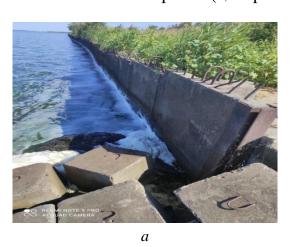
Первая очередь строительства берегоукрепления (автор фото С. Я. Семененко) Figure 6 – First stage of bank protection construction (photo by S. Ya. Semenenko)
